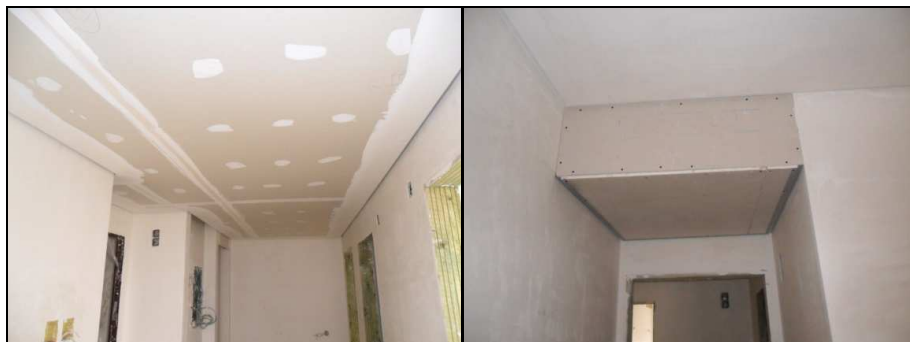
27 - Tecto falso no hall de entrada e pormenor em quarto
